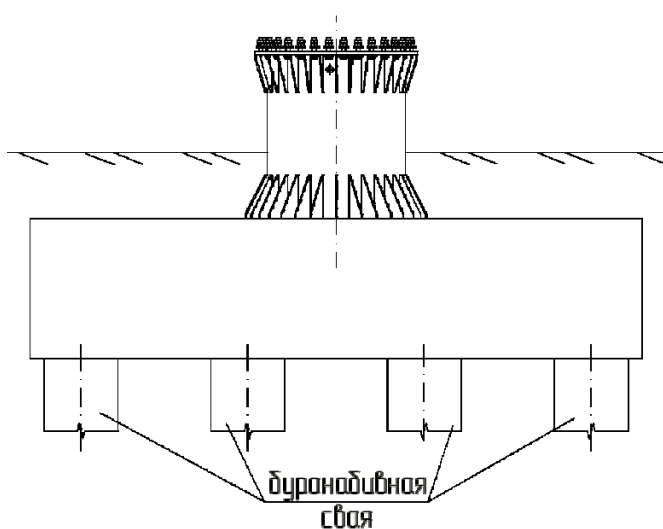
Двенадцатисвайный фундамент из буронабивных свай. Схема установки.
